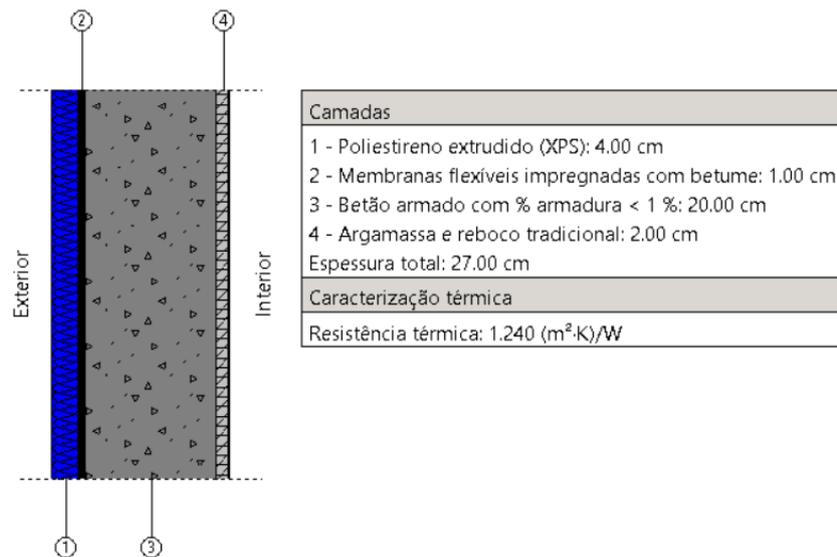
Muro de Suporte, Fonte: CypeTherm Loads
